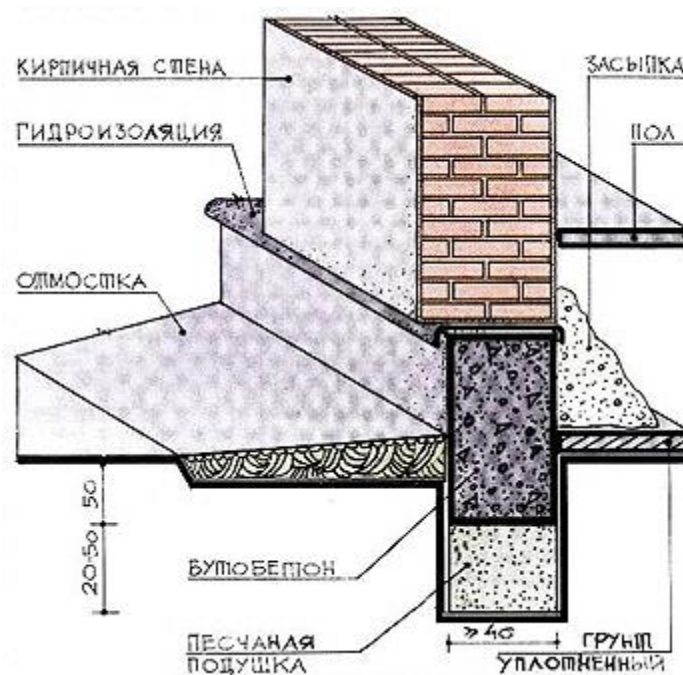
Монолітний стрічковий бутобетонний фундамент
